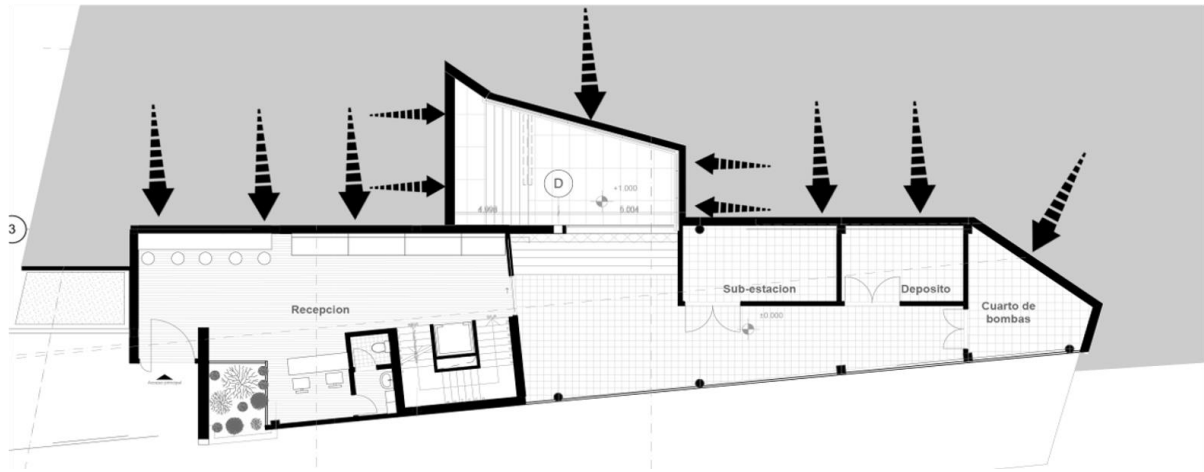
esquema de cimentación y cargas aplicadas (muros de contención). Imagen del autor
